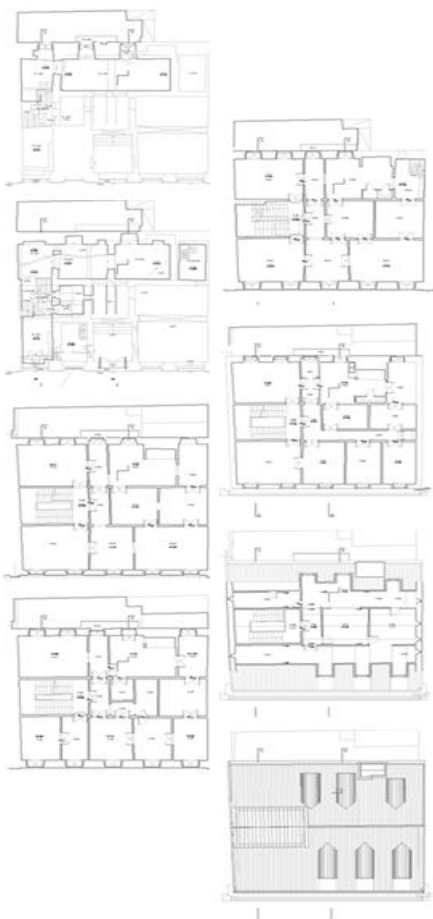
Planta sem escala dos andares do edifício estudado, da Rua da Madalena, por ordem crescente, 1º (esq.)cave, 8º(dir.) telhado, fonte Arquivo Municipal de Lisboa, autor desconhecido.
